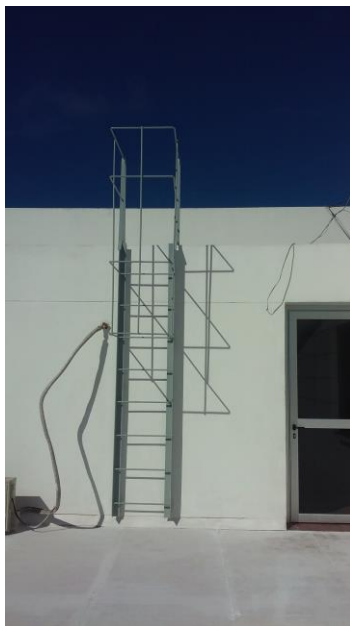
FOTO DE ESCALERA MARINERA EXISTENTE PLANILLADA TIPO H18
